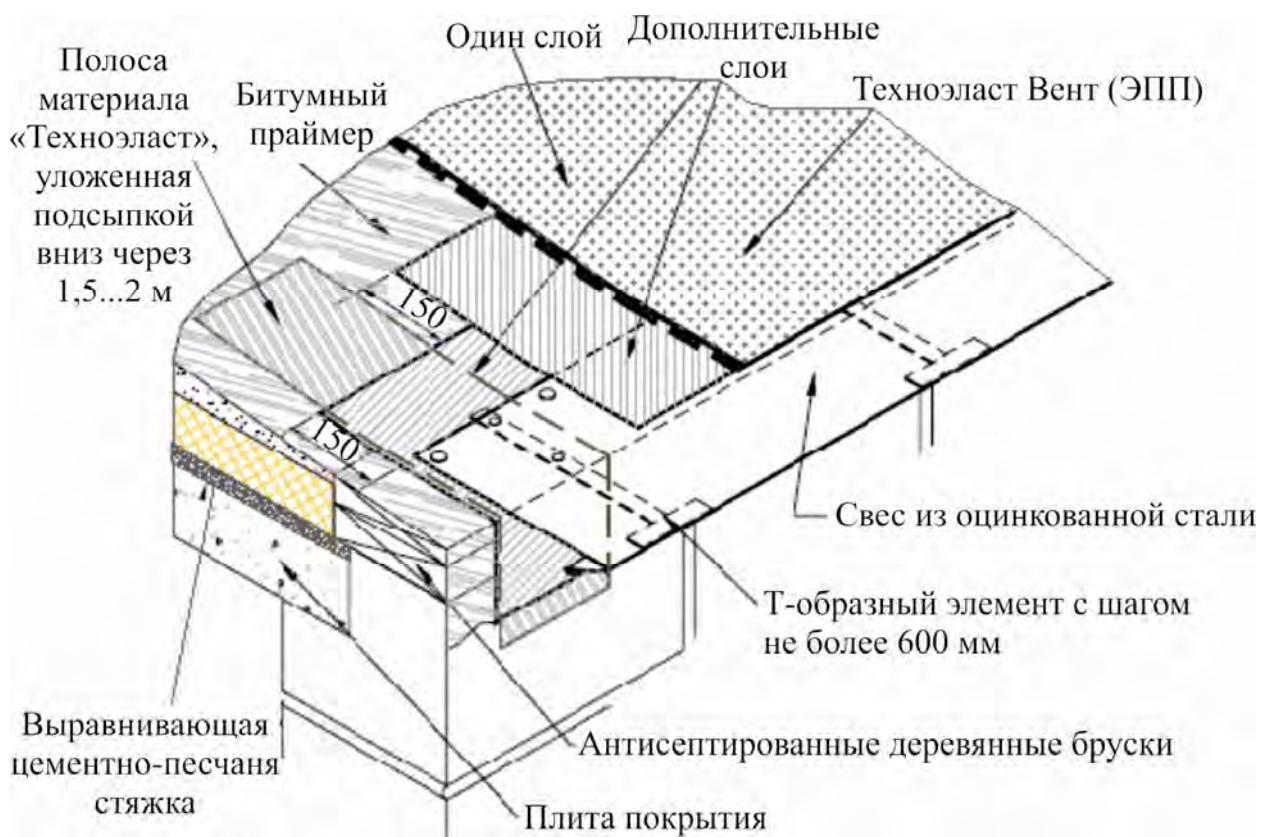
Организация примыкания кровли над лестнично-лифтовой шахтой
